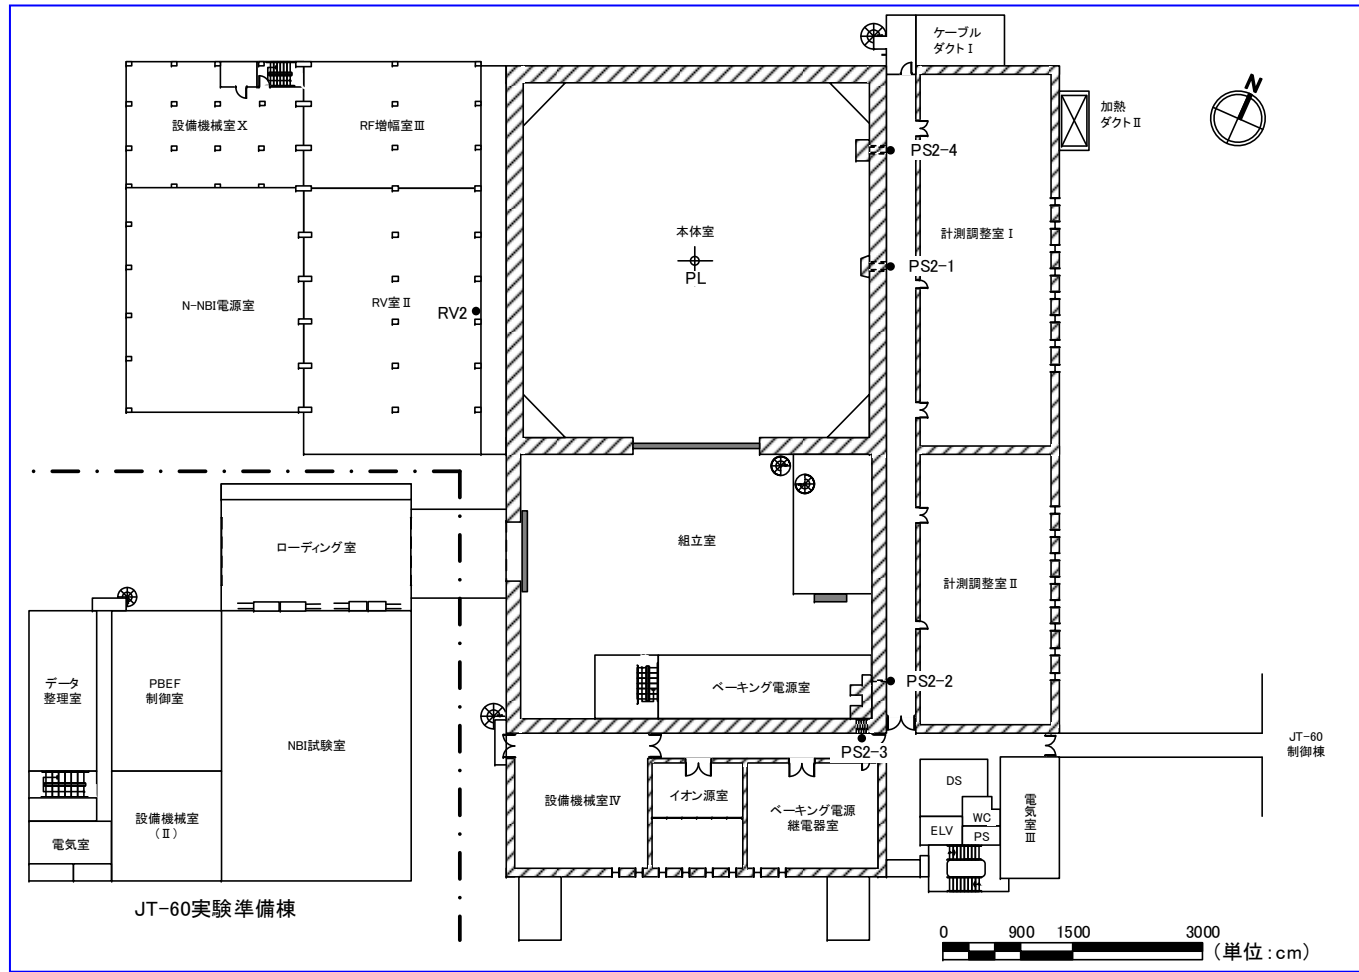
1. 5. 2 JT-60実験棟2階平面図 (単位: cm) (改修前)
